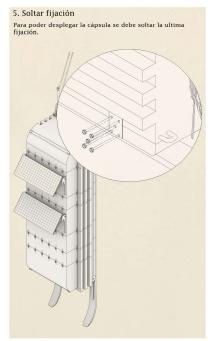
Instructivo de armado cápsula 1. Elaboración propia.
